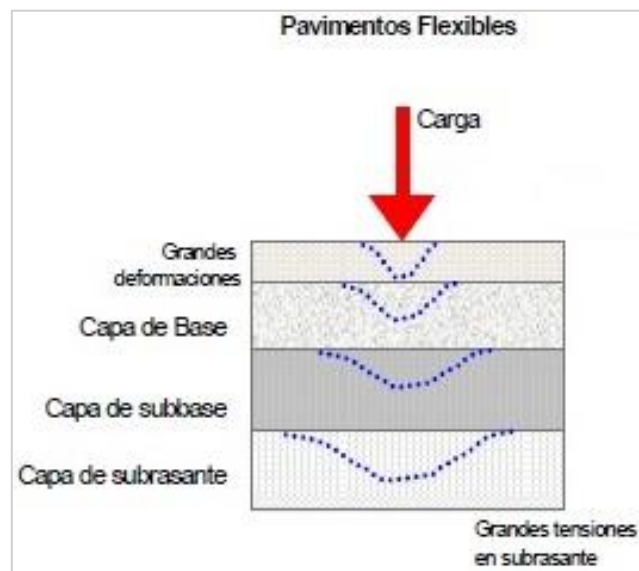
Esquema de comportamiento y capas de un pavimento flexible.
